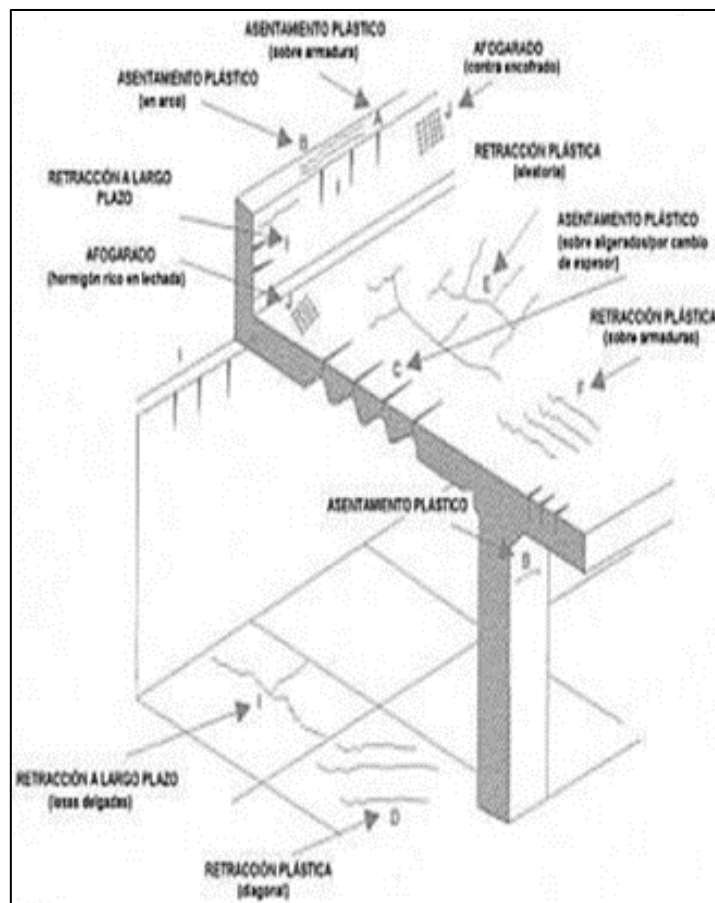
Representación esquemática de la propagación de las fisuras por retracción plástica
